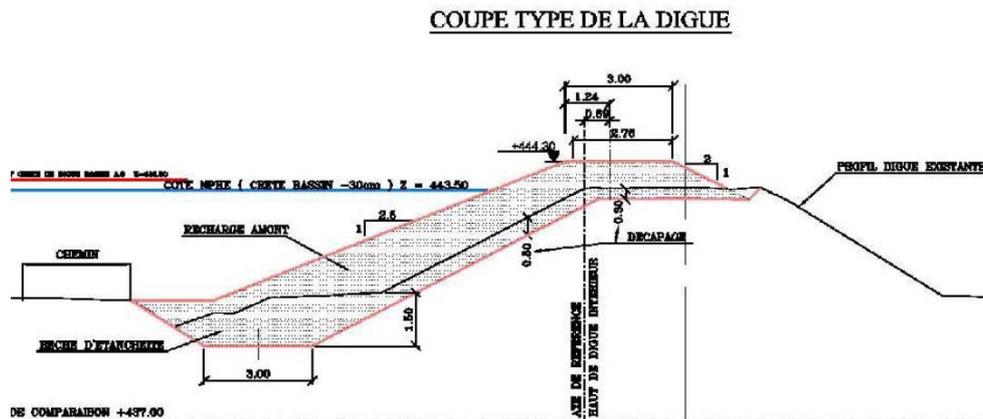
coupe type d'une digue avec étanchement par une recharge amont étanche (source SAFEGE 2007)
